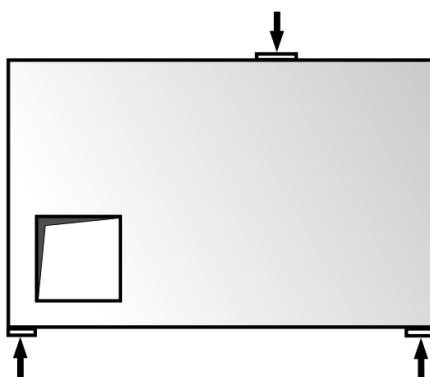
Viga Parede com Furo Retangular (SCHLAICH; SCHAFFER; JENNEWAIN, 1987).
